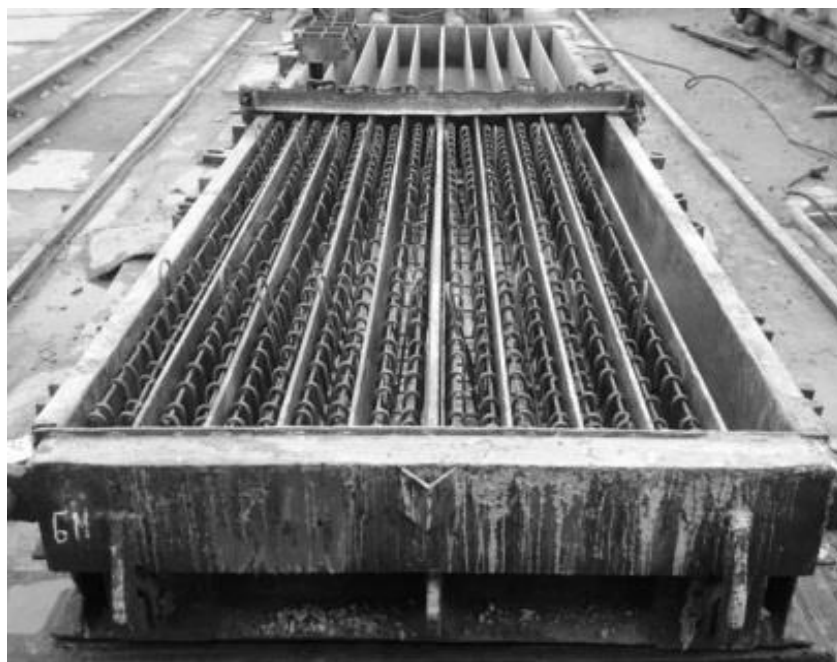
Опалубочна форма з арматурними каркасами зразків балок
